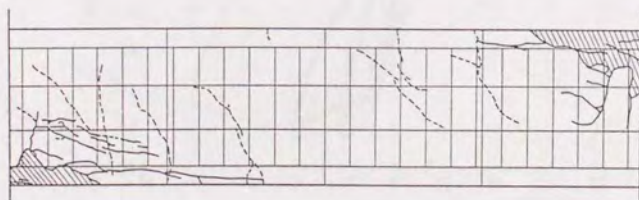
ひび割れ状況 (試験体 87)
